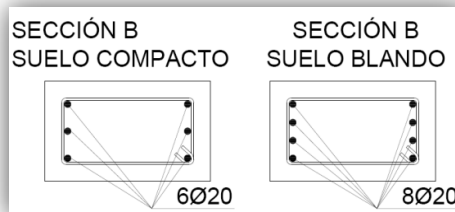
b) Detalle armadura longitudinal Columna Rectangular, sección B
